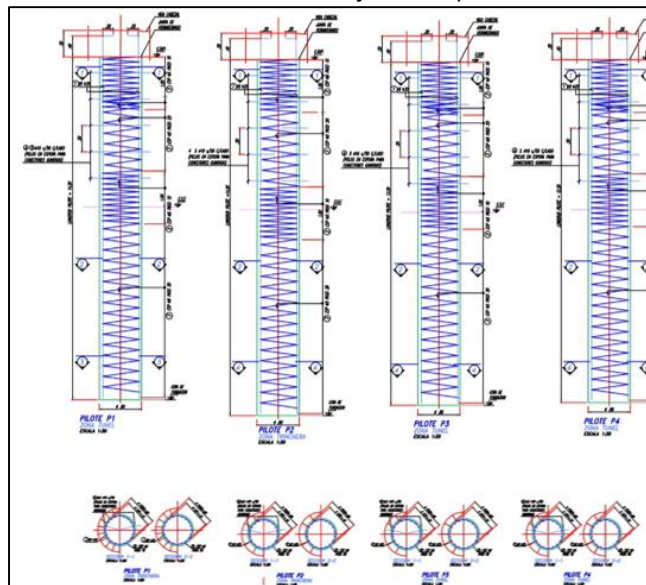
Tipos de pilotes. (PLANO N° 24)
